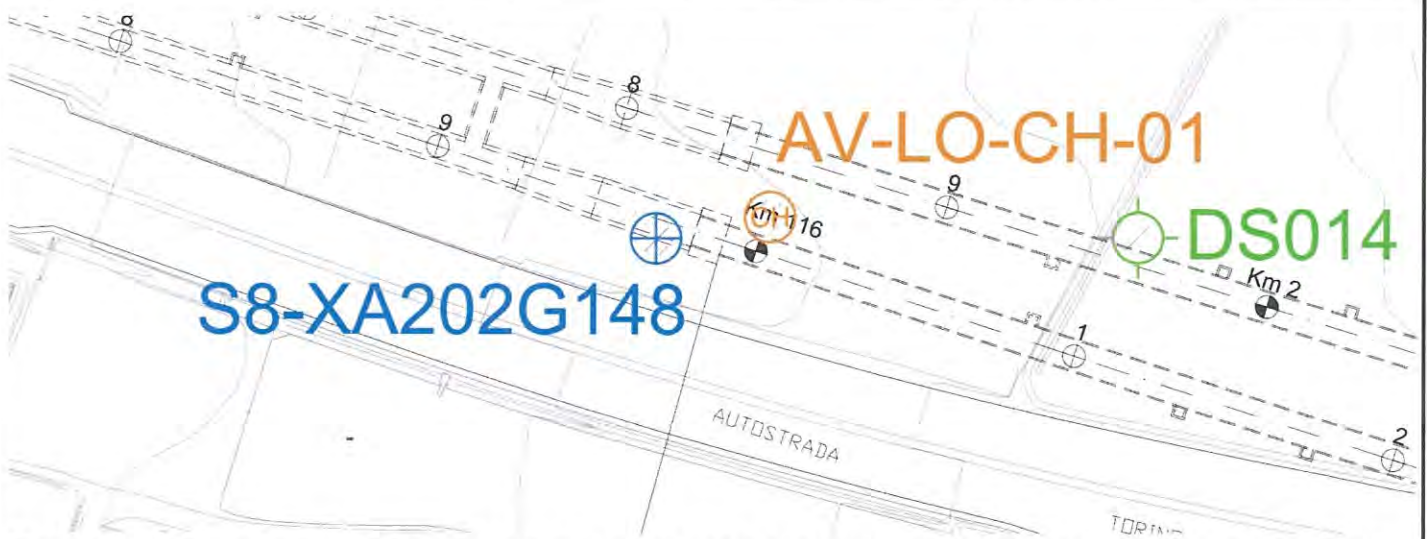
Stralcio planimetrico con l'ubicazione dei sondaggi in corrispondenza dell'imbocco lato Milano della galleria naturale.
